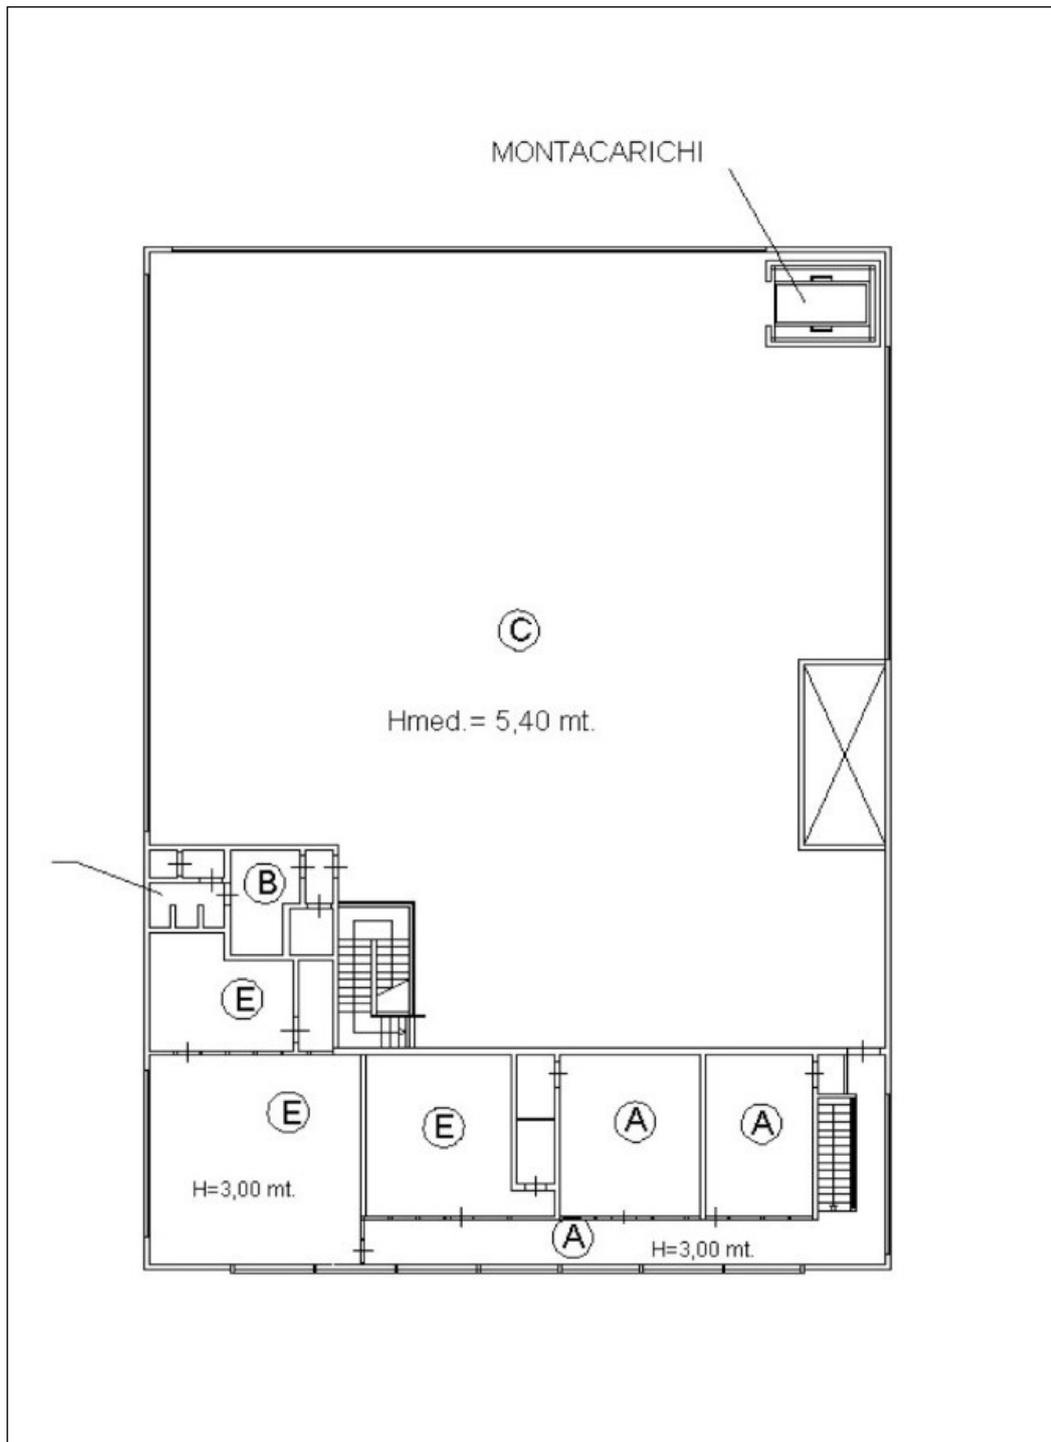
Stralcio della planimetria catastale del 06/05/2008. Primo piano.
